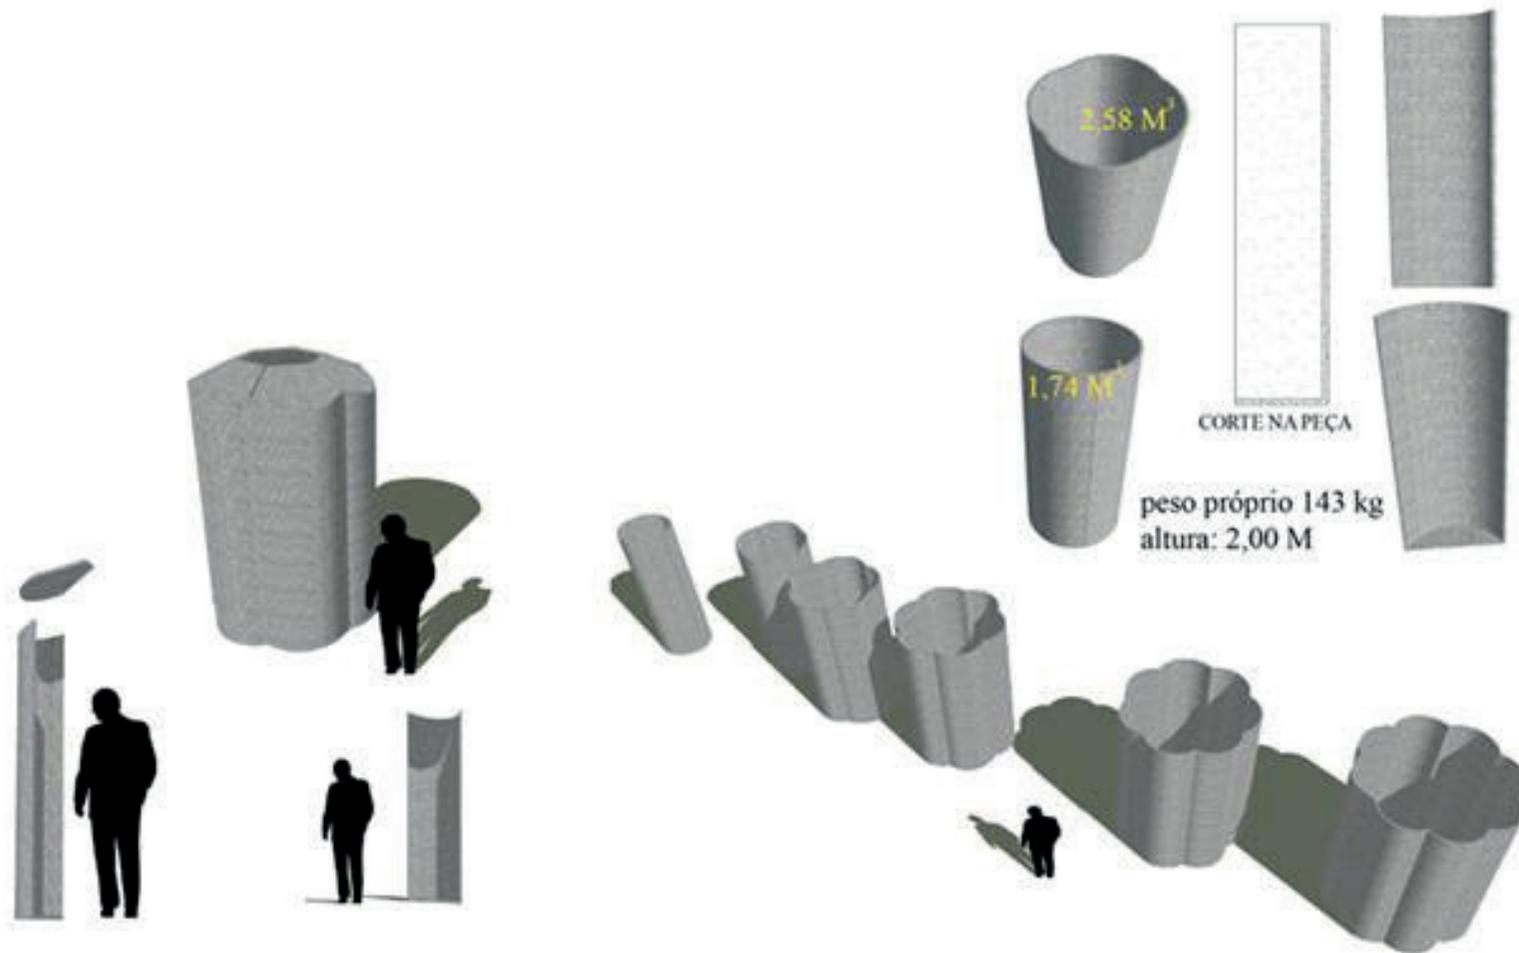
Cisterna pré-fabricada em argamassa armada.
